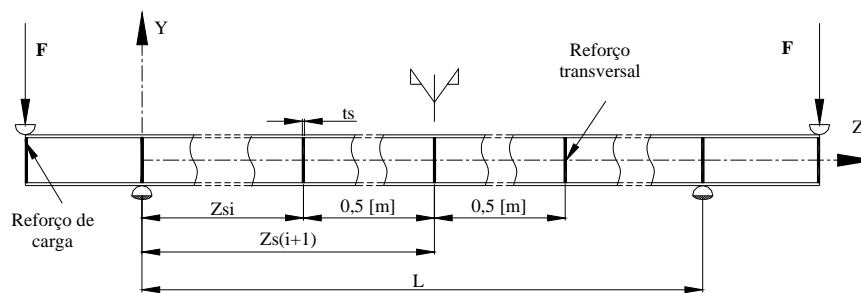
Modelo do ensaio realizado nas vigas reforçadas.
